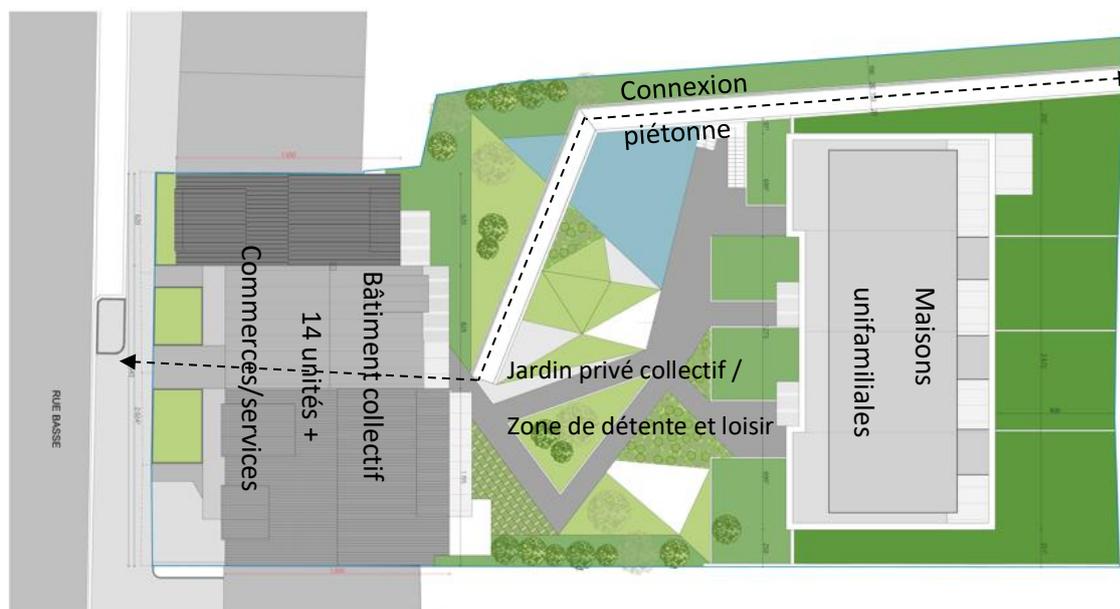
plan de situation - à titre indicatif (Source : ZAK architect)
